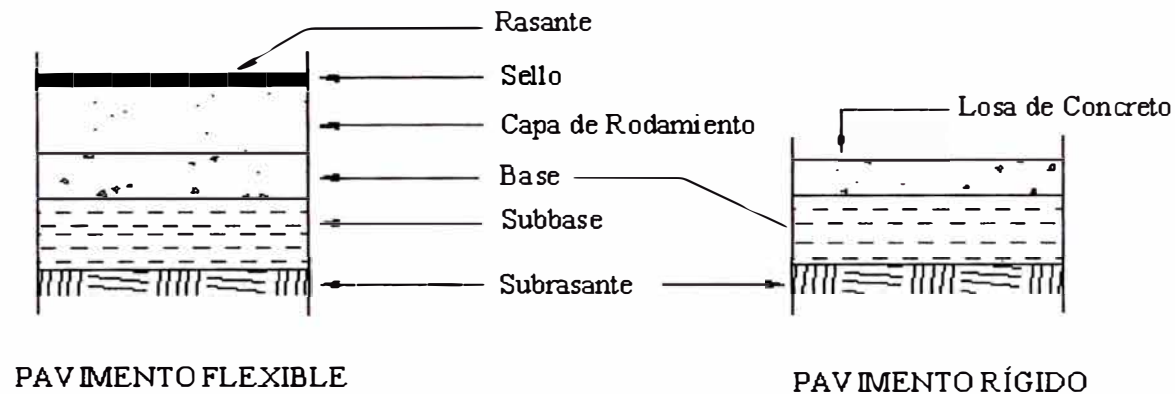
Capas típicas de los pavimentos flexibles y rígidos
